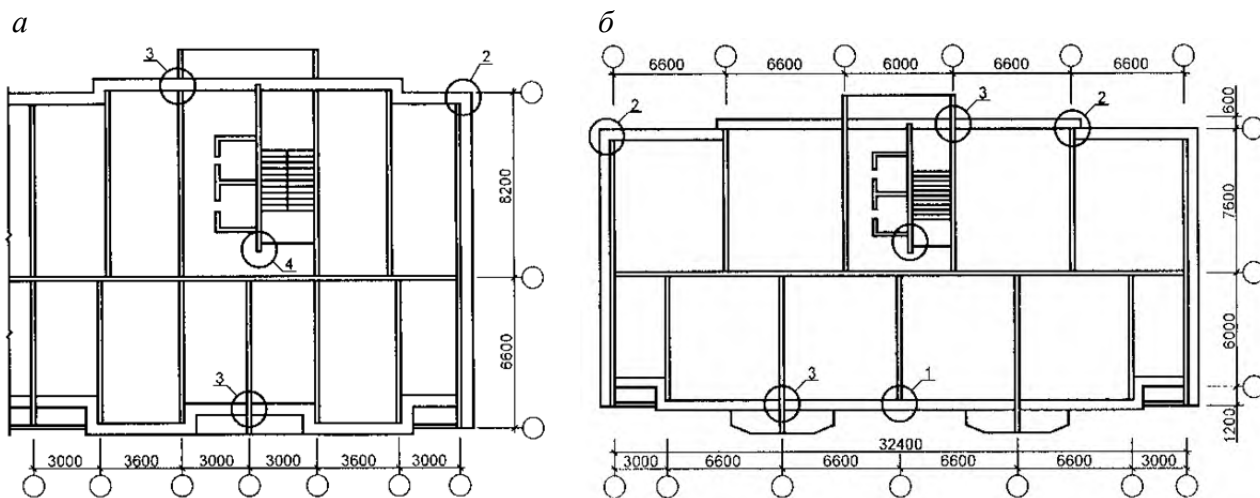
План стеновой конструктивной системы из монолита:
